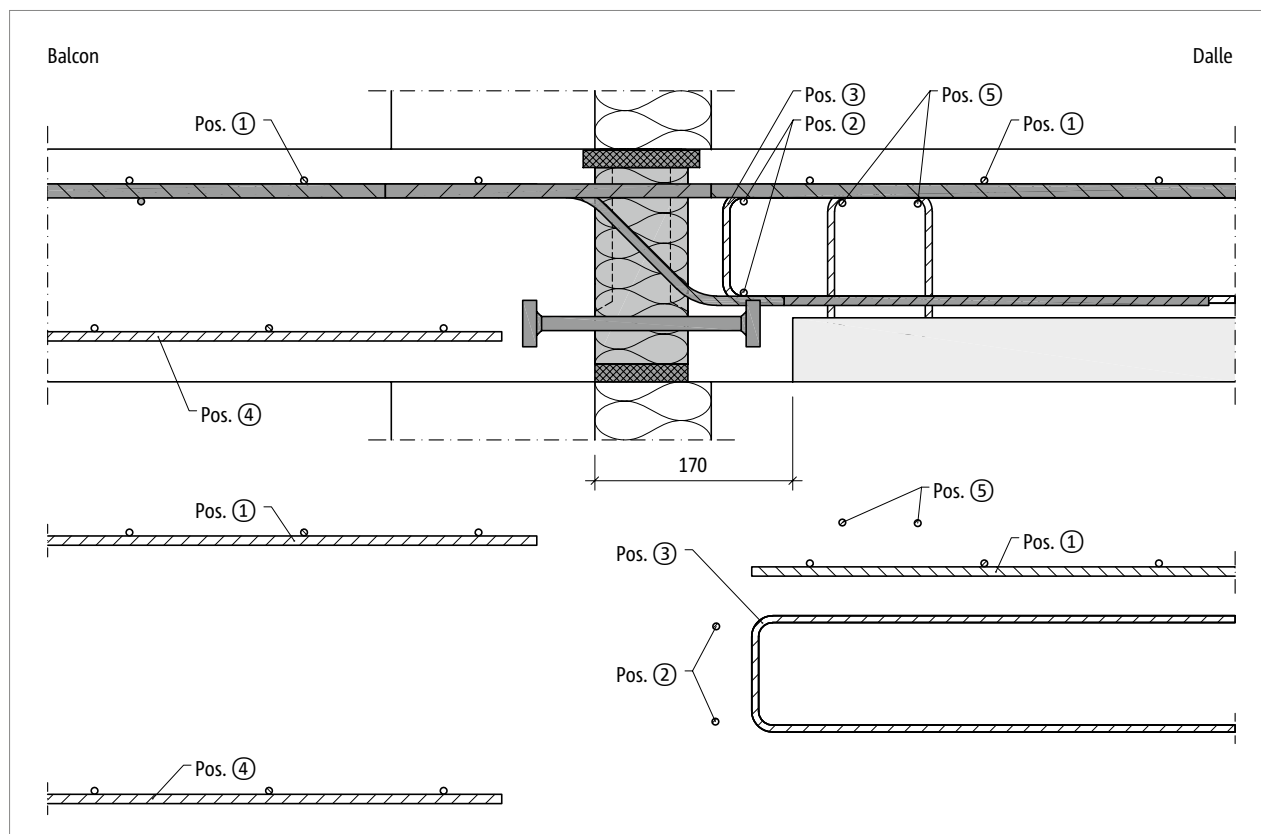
Schöck Rutherma® T type DB : armatures à prévoir par le client en association avec des planchers avec prédalles
